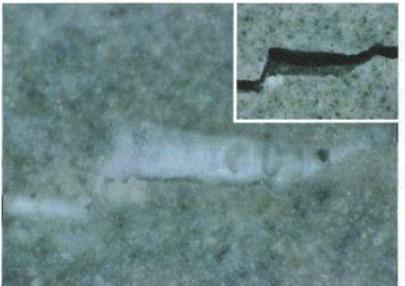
■ 右は幅0.2mmのひび割れ。上は水を供給して日後にひび割れが閉塞した様子(写真2のページはCORE技術研究所)
